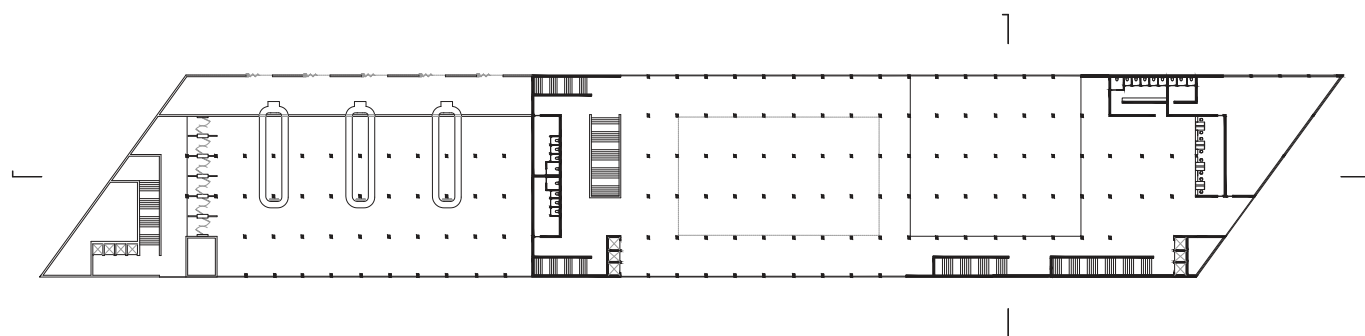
PLANTA DO PISO 1 DO TERMINAL DE CRUZEIROS
